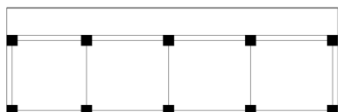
El sistema constructivo es principalmente de columnas y vigas (marco estructural), con losa tradicional. Las vigas son de doble sentido, para cubrir la luz y hacer estable la estructura. Este también beneficia para soportar los esfuerzos que producen los pasillos. Fuente: Propia.
